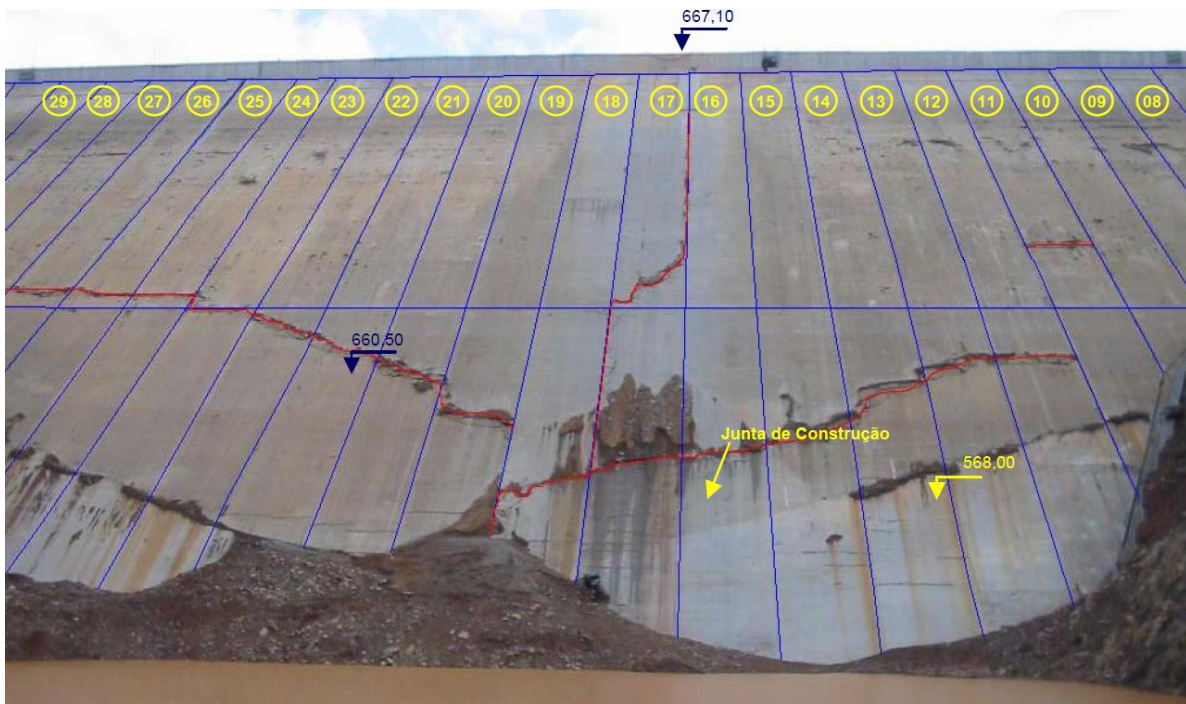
Vista geral das lajes trincadas, UHE Campos Novos (SOBRINHO et al., 2007).
